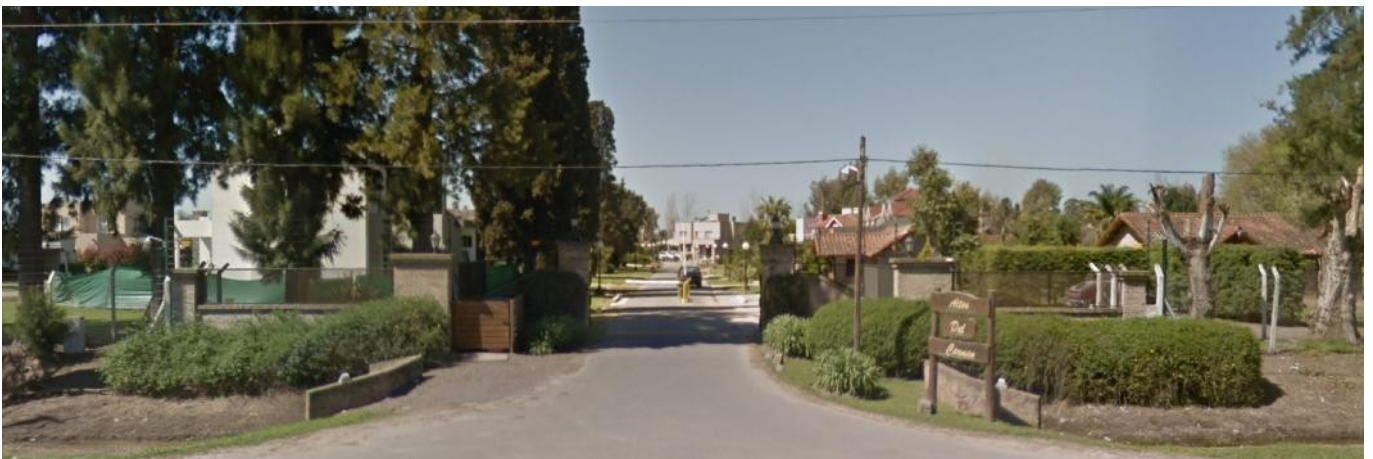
Acceso Lateral con Alcantarillado - Margen Descendente
